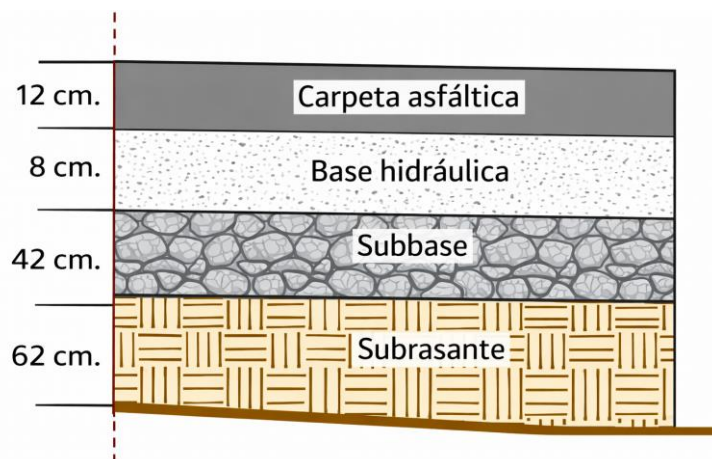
Estructura de pavimento en el cálculo de esfuerzos.
